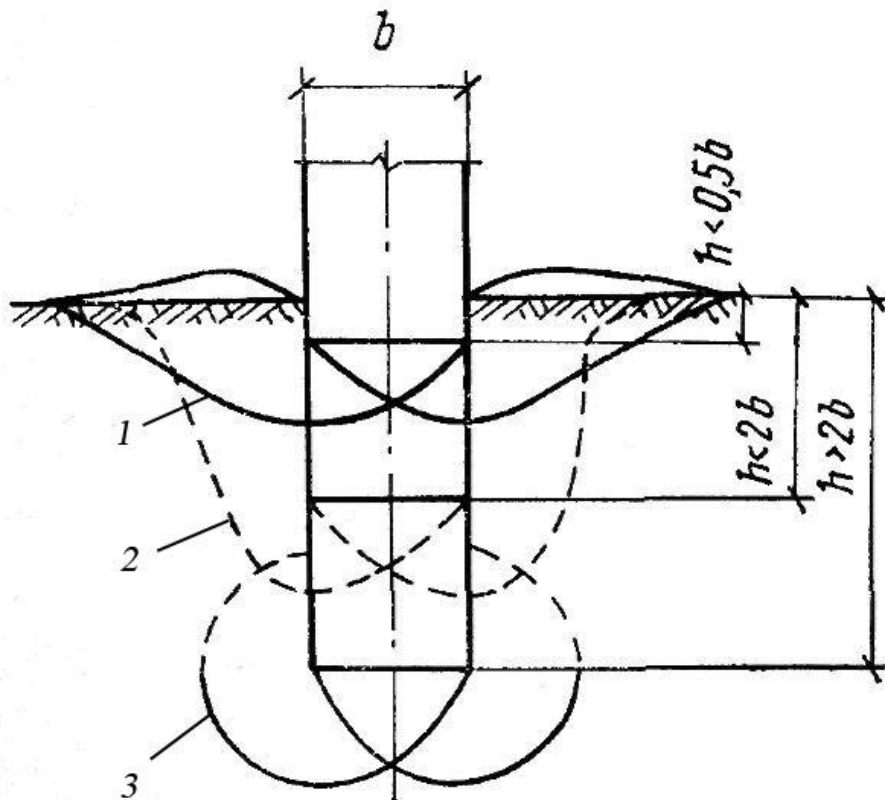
Схема розвитку деформації в ґрунтах при різній глибині закладання фундаментів h шириною b :
